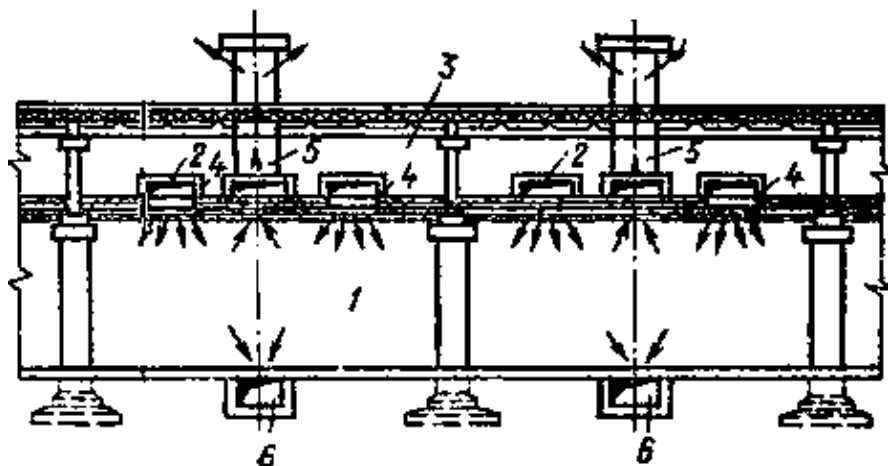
Схема приточно-вытяжной вентиляции производственного здания:
